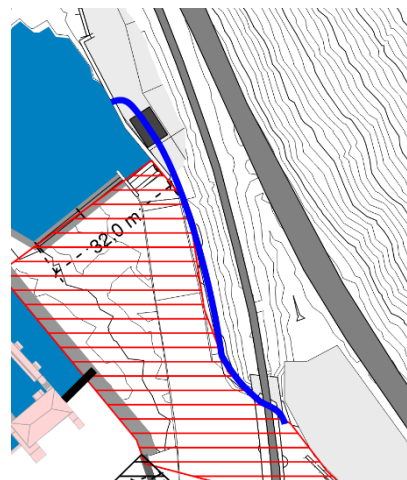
Skisse med planlagt tiltak sett i forhold til eksisterende konstruksjoner
